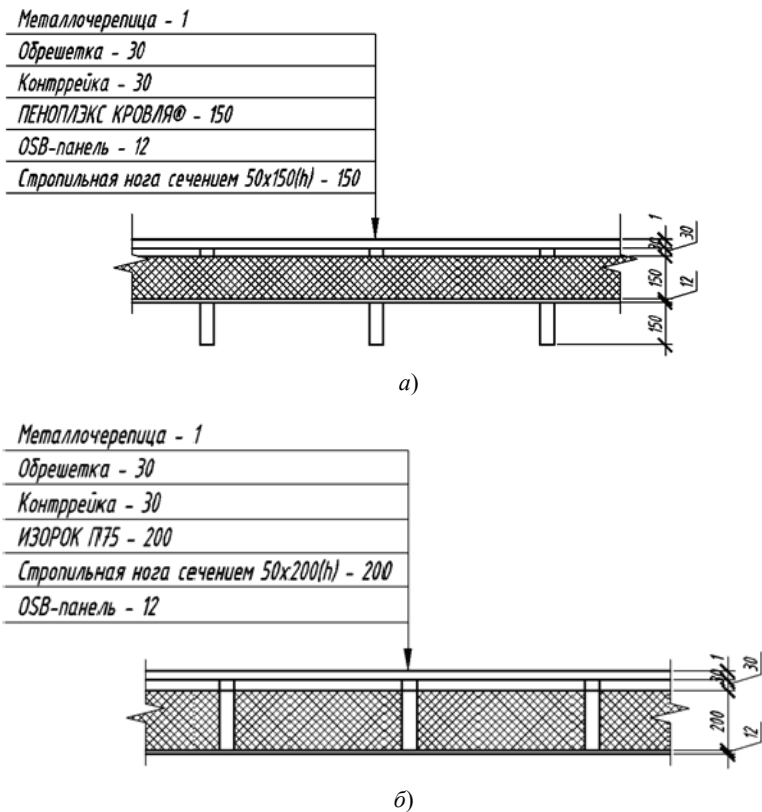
Конструкция кровли дома по вариантам 1 (а) и 2 (б)
